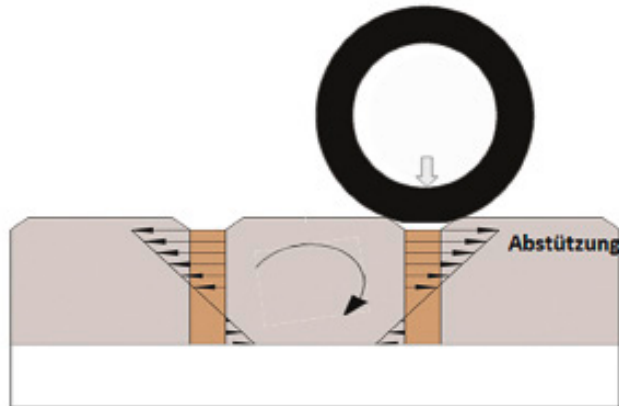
Bewegungsablauf beim Überfahren einer Pflasterfläche (Belastung auf der Bettungsschicht) [Quelle: Buchholz]
